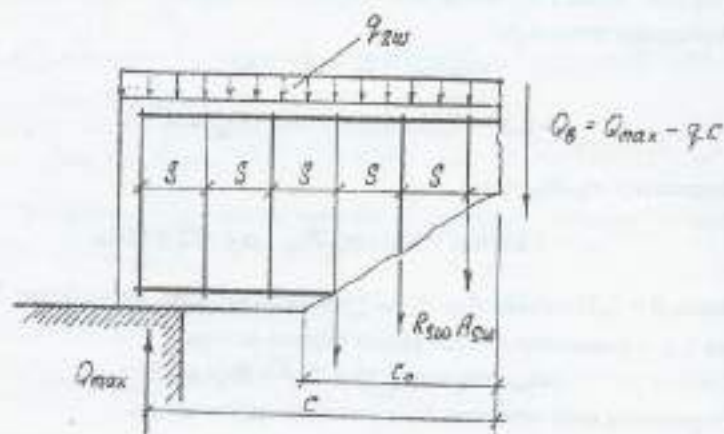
К расчету наклонного сечения на действие поперечной силы
